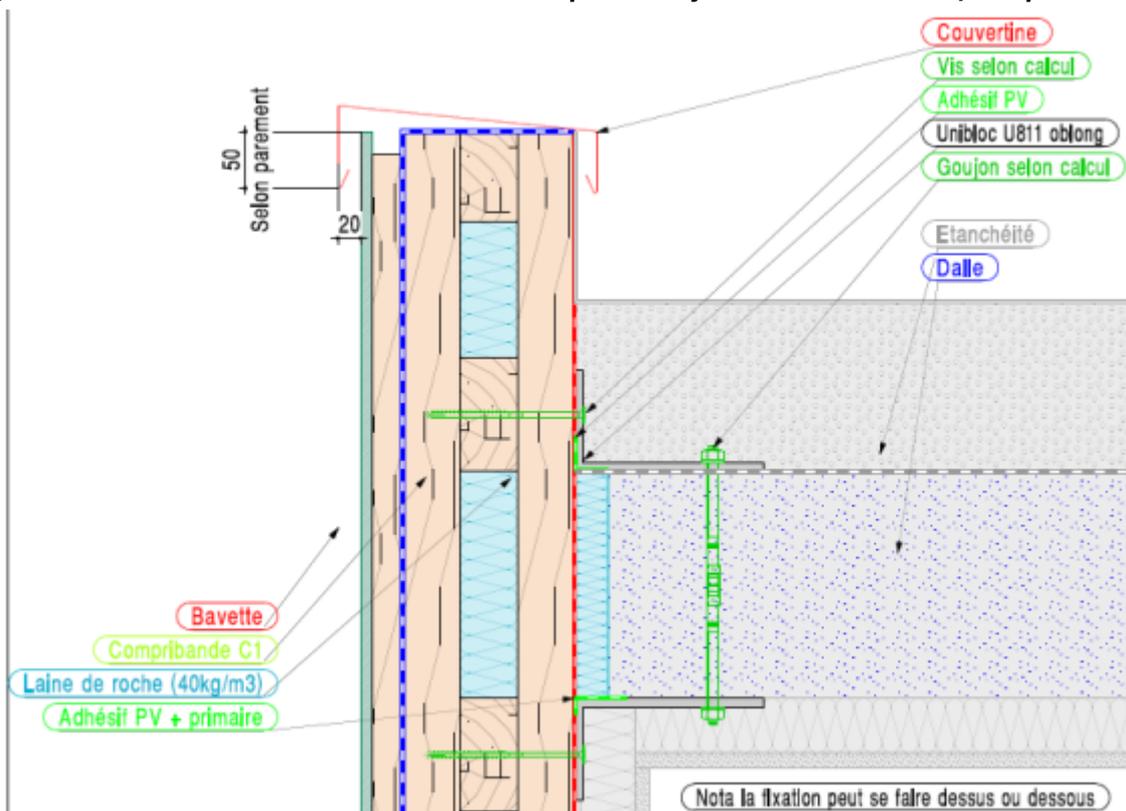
Jonction sur dalle béton en acrotère / Coupe verticale
